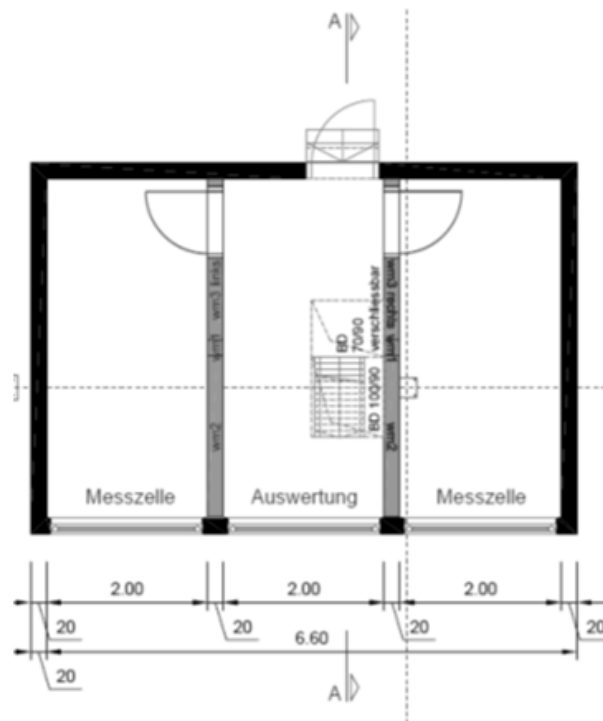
Grundriss des Fassadenprüfstands im EG (identisch im OG)
